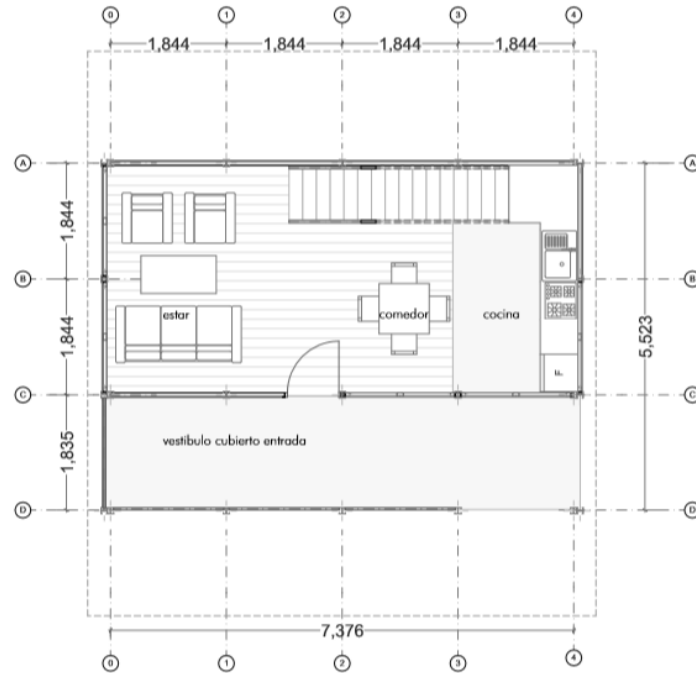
Plano arquitectónico de la planta baja de la vivienda de 2 plantas (Opción A)
